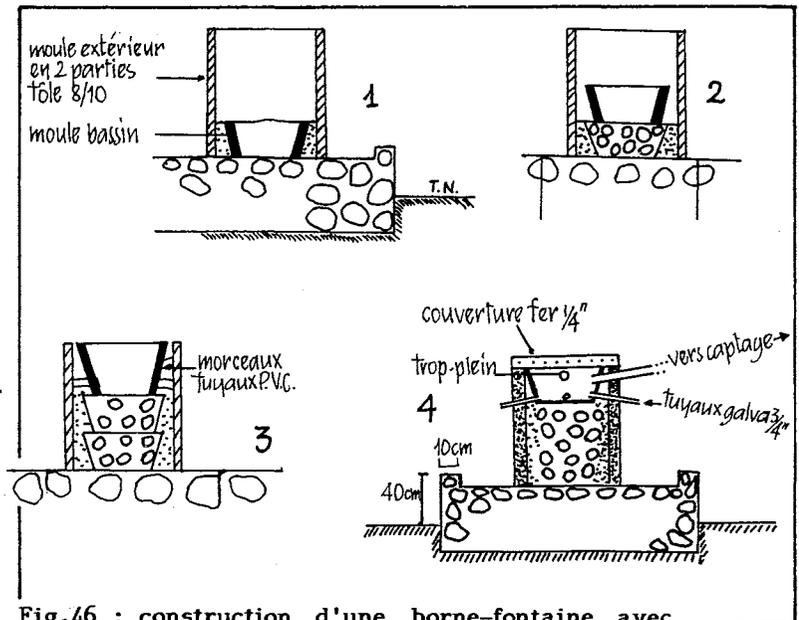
construction d'une borne-fontaine avec un moule type (Jacmel, Haïti).
